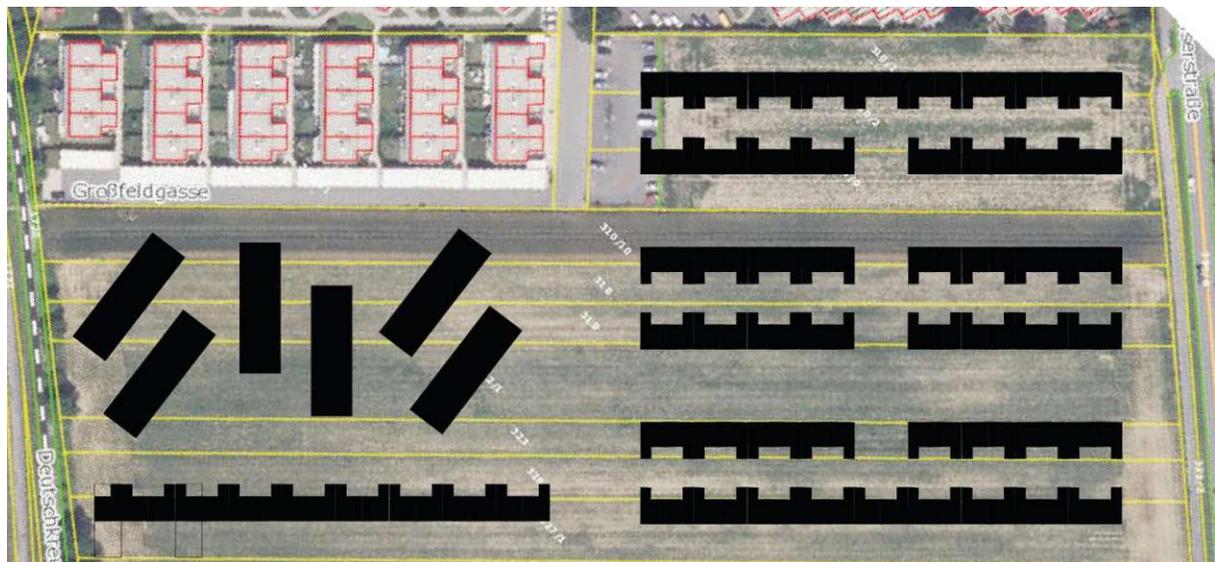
Darstellung der einer möglichen Bebauung entsprechend dem Bebauungsplan (Quelle: eigene Darstellung).
